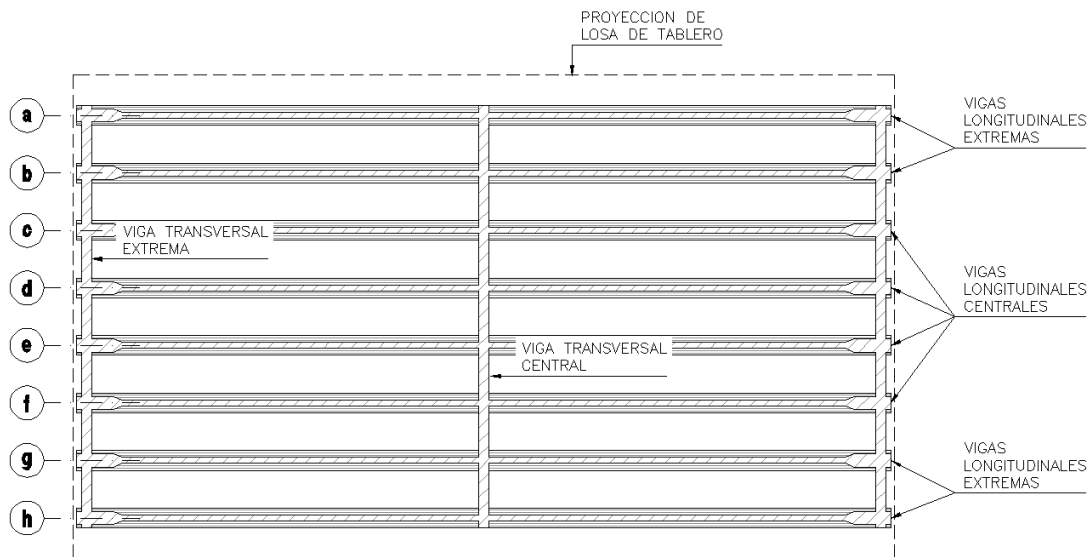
Esquema de disposición de vigas centrales y extremas.
